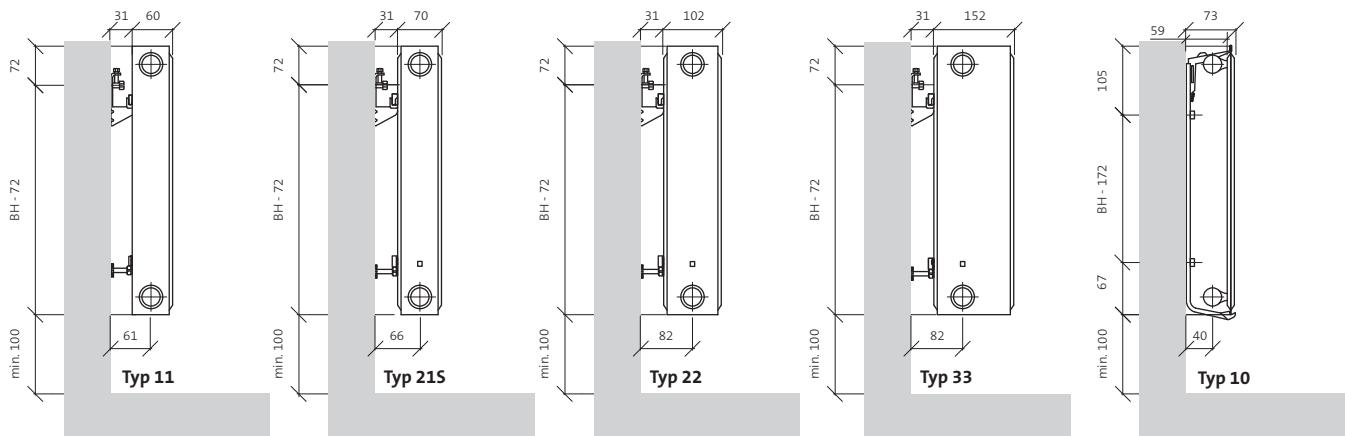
Montagemaße für Compact mit Befestigungslaschen
